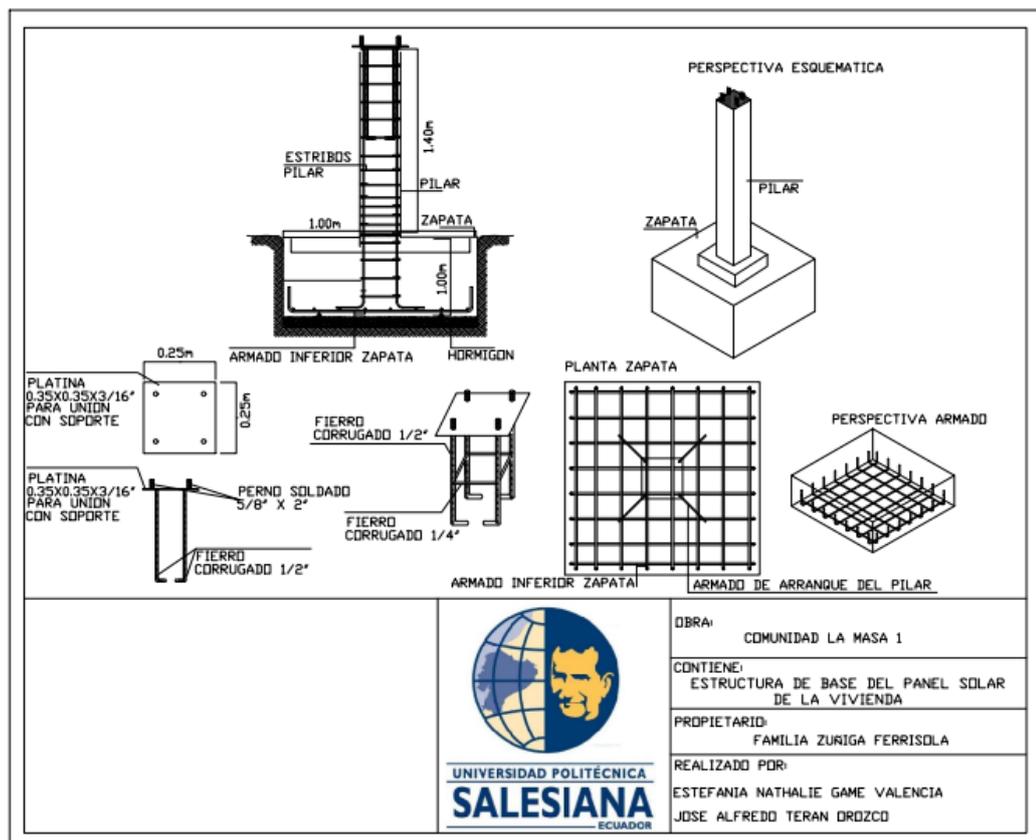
Estructura de base de los paneles solares a instalar en la vivienda (Fuente: Autores).
